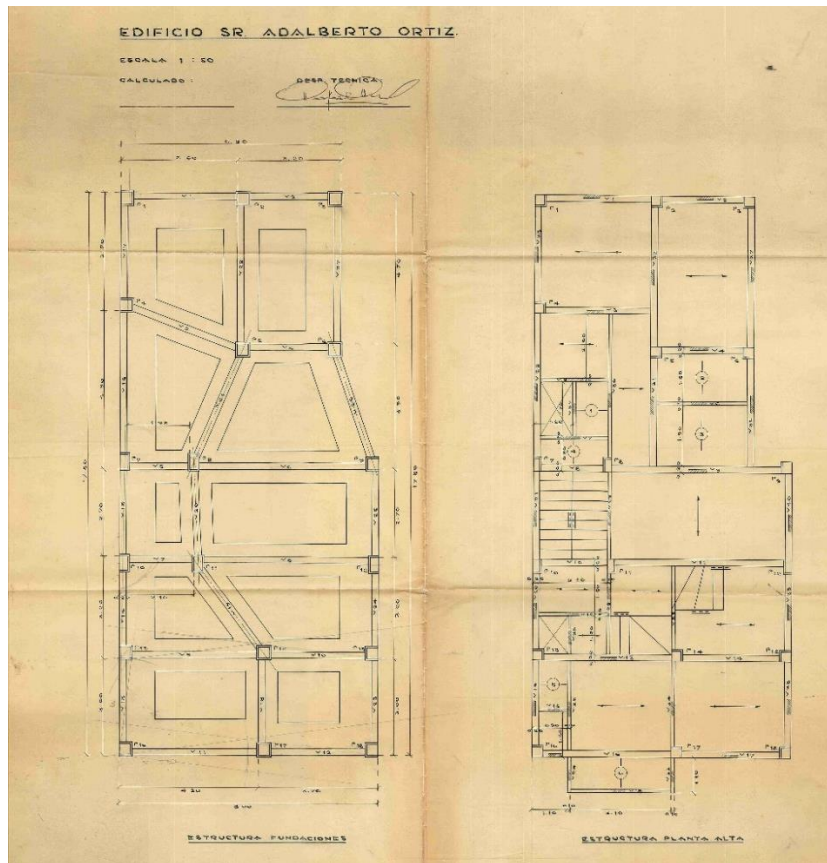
Plano de estructura fundaciones y planta alta (Archivo Rivas, 1961)
